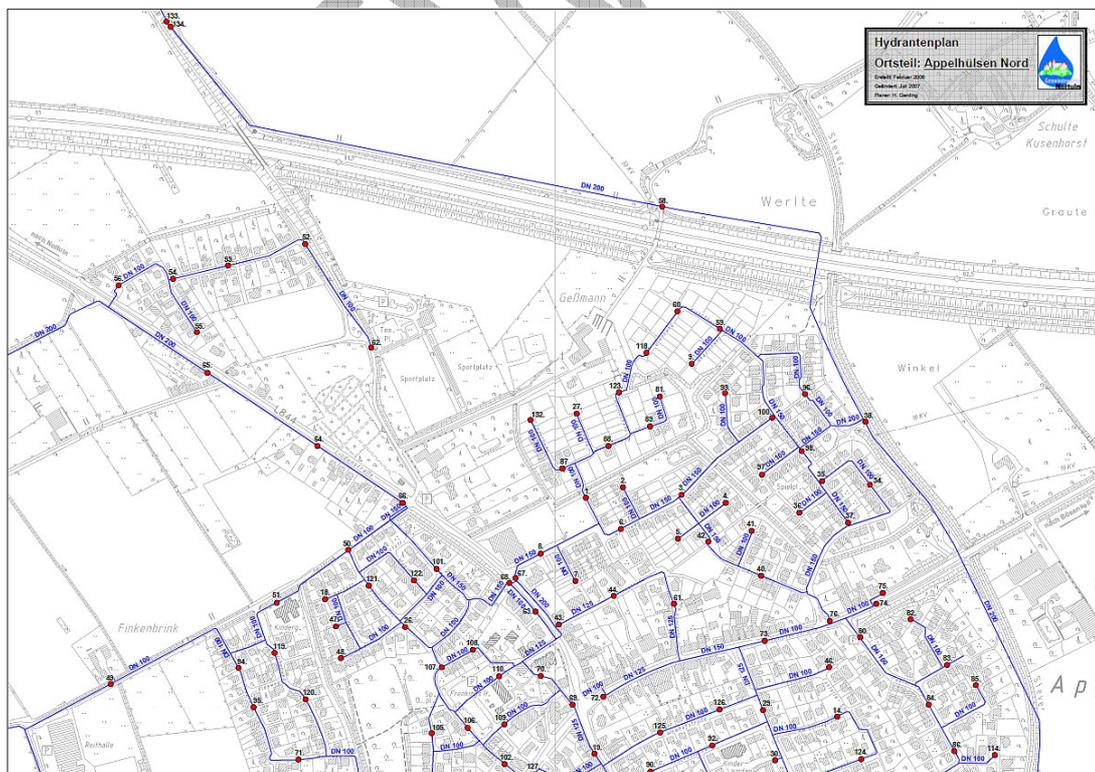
Trinkwasserversorgungsnetz mit Hydranten, Detailplan Appelhülsen Nord
